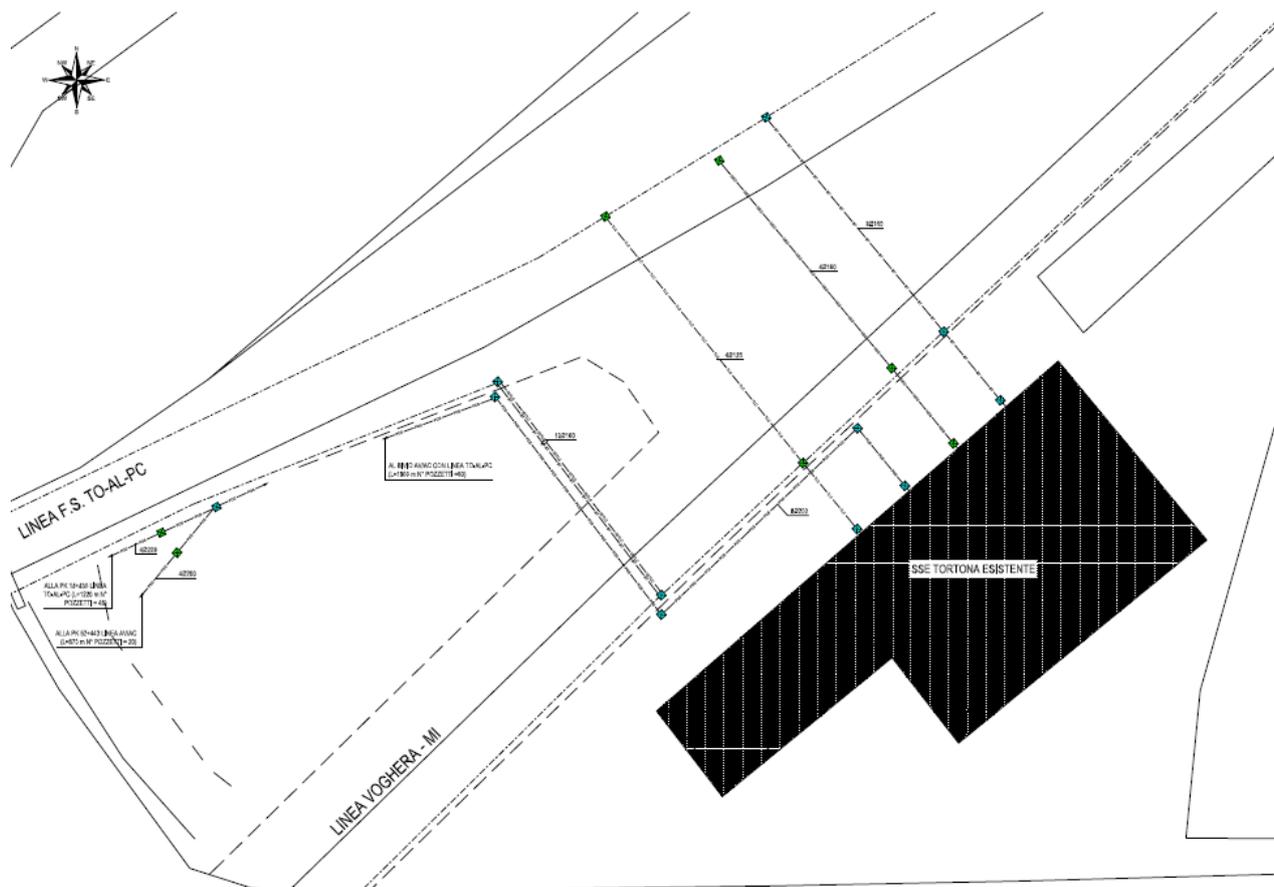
Planimetria sottoservizi area fabbricato SSE
